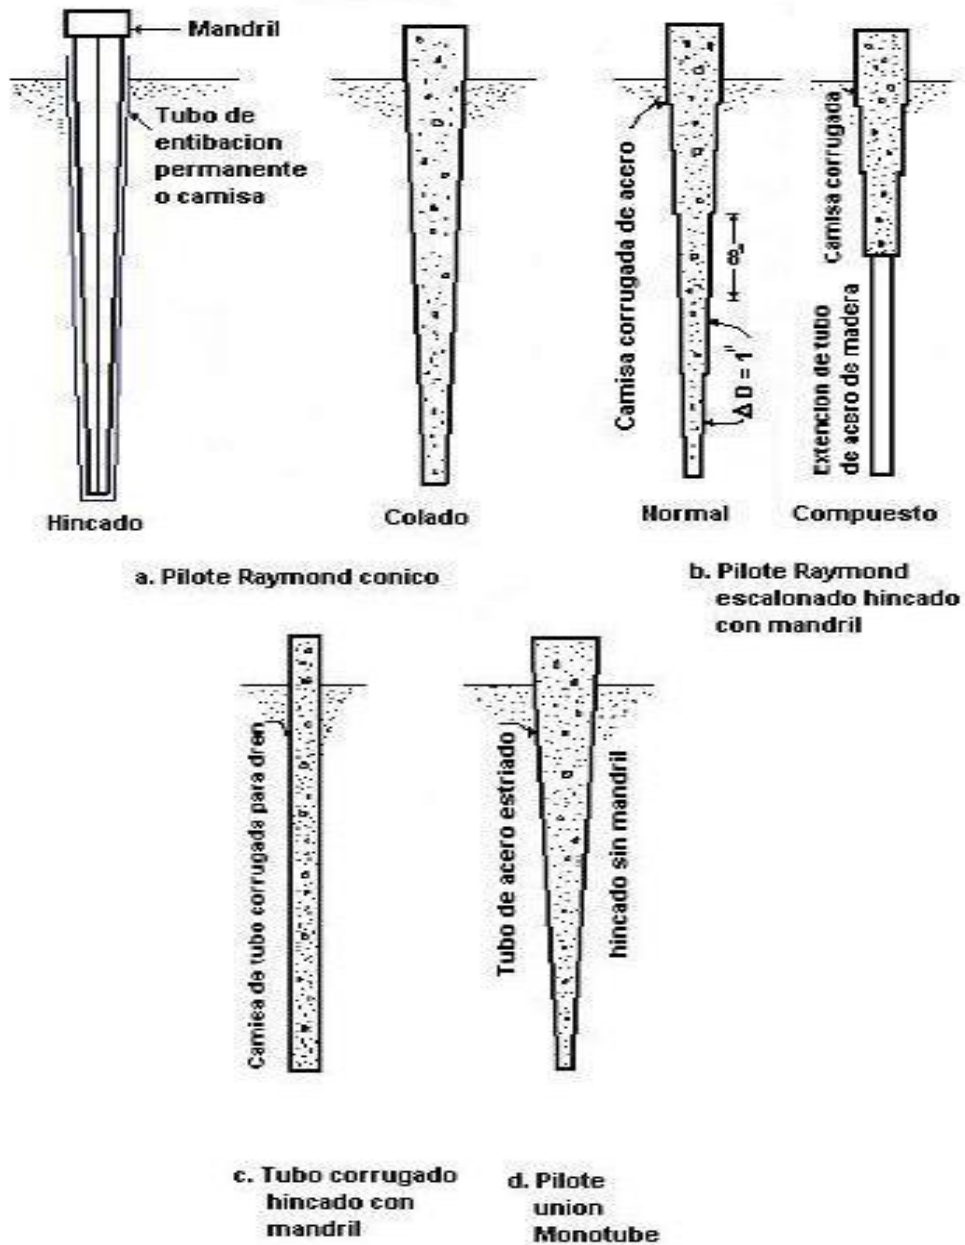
Pilotes de hormigón fabricados “in situ”
